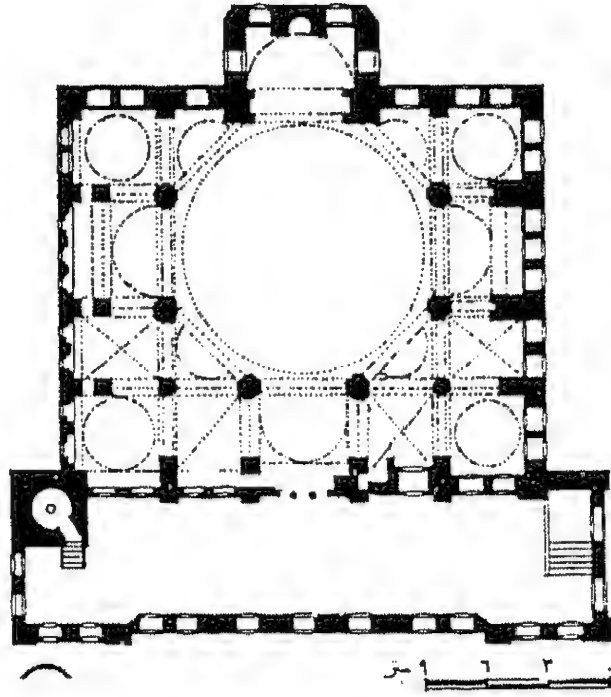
مسقط أفقي لمسجد بيالي باشا في إستانبول (عن : جابريل)
